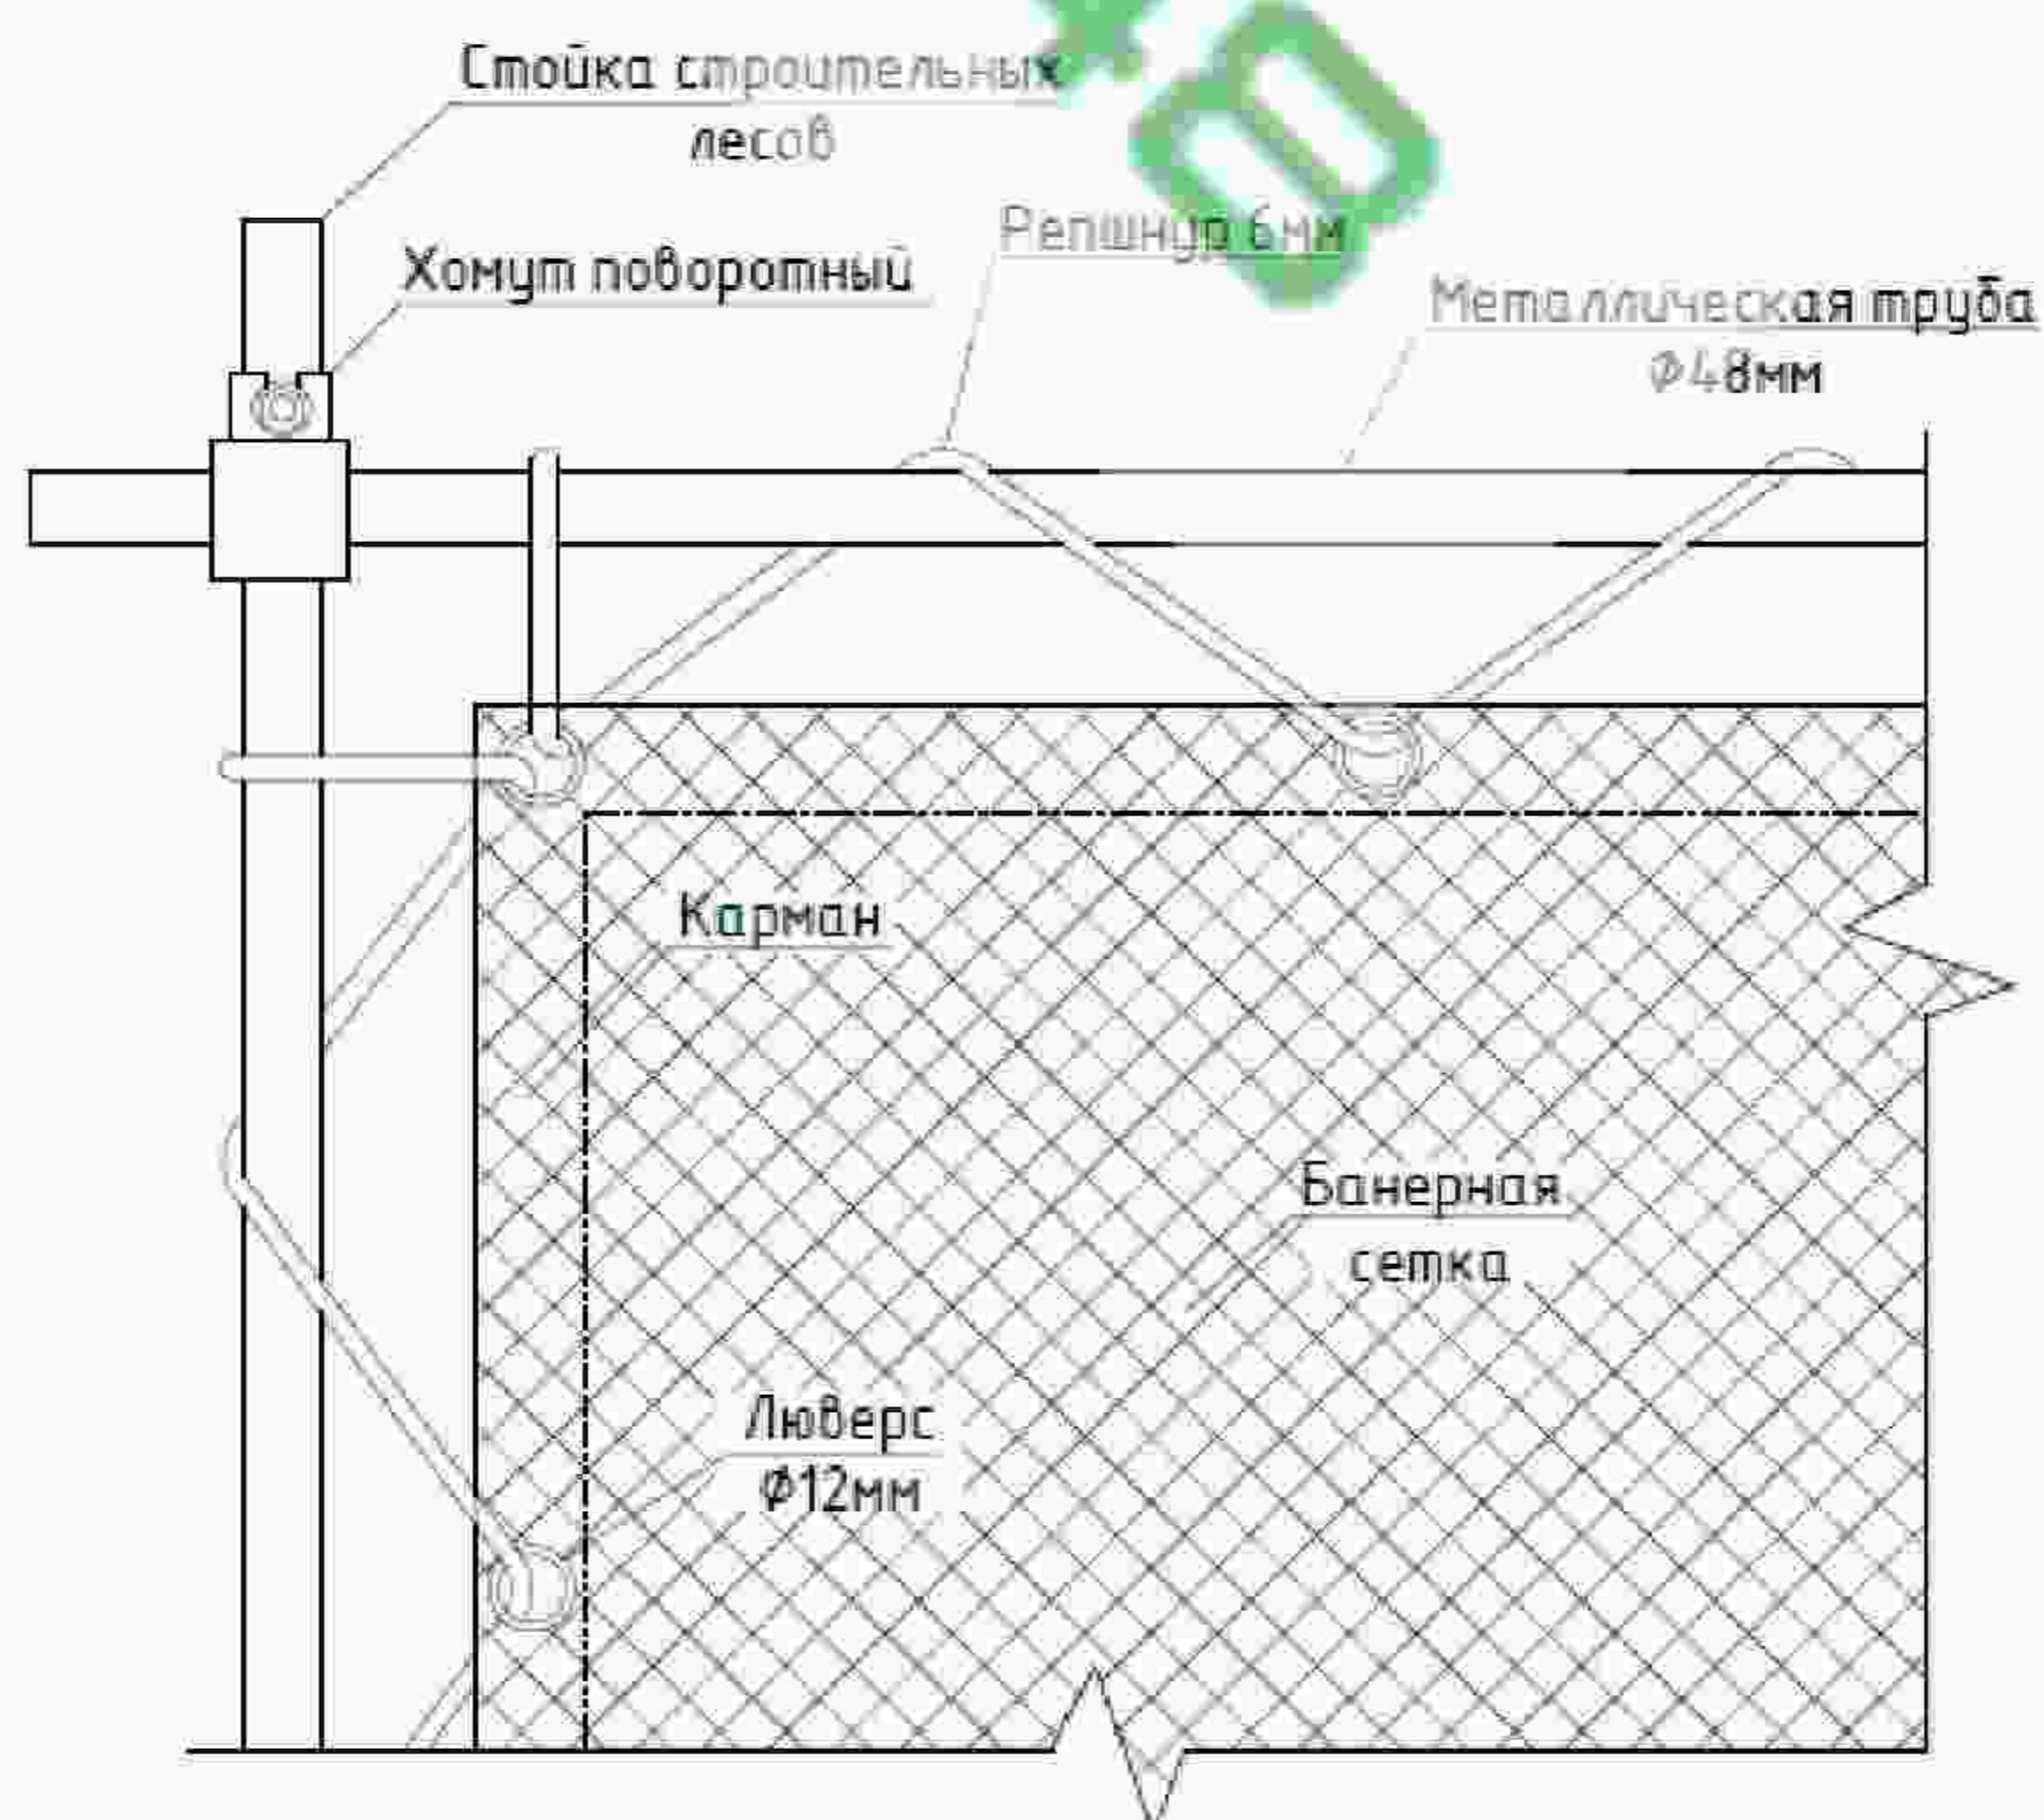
Схема крепления баннерной сетки к м/конструкциям строительных лесов через люверсы
